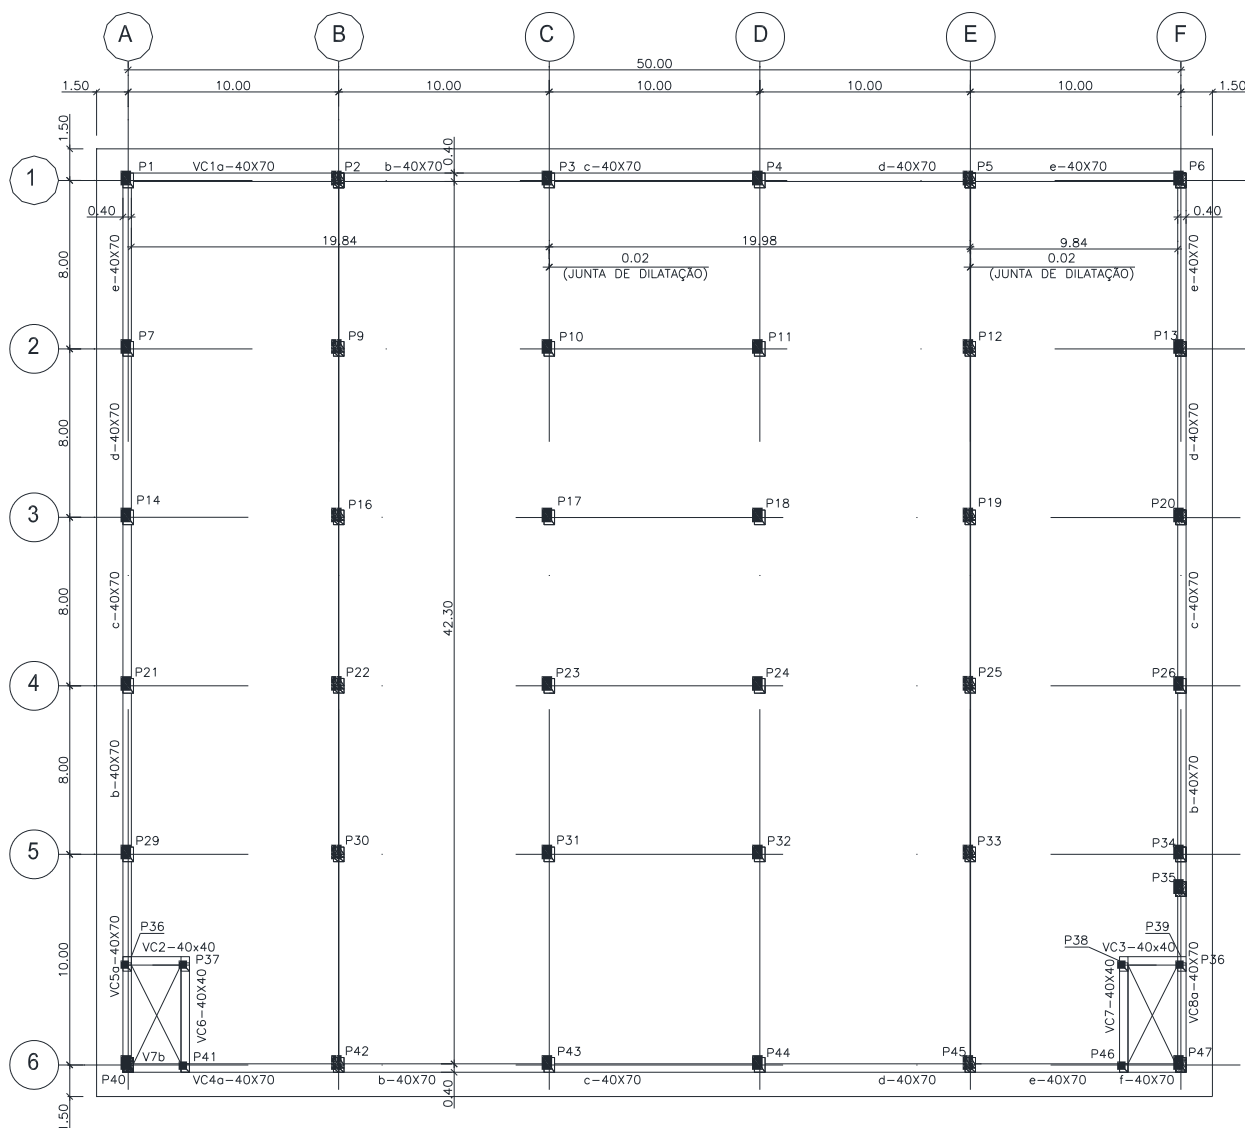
Fôrma – Planta Baixa teto da cobertura
